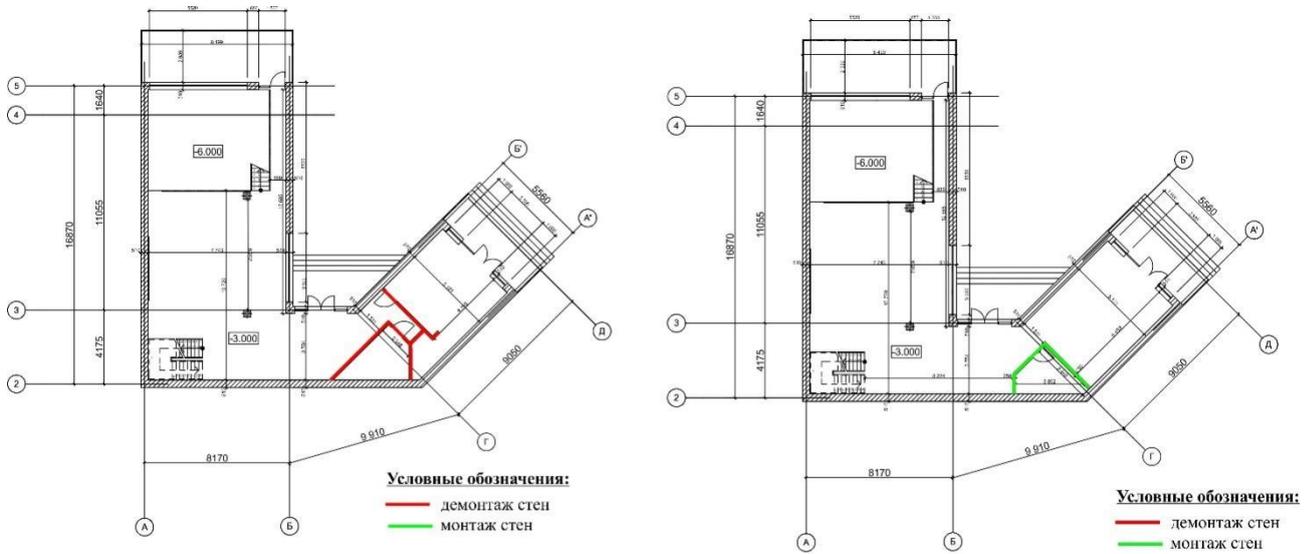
План демонтажа и монтажа -1-го этажа на отметке -3.300
